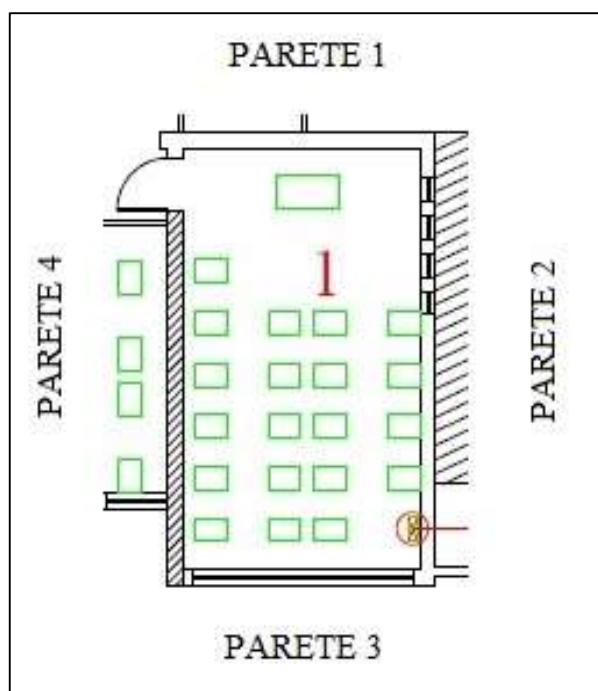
Planimetria dell'Aula 1 (3°B) oggetto di misurazioni
